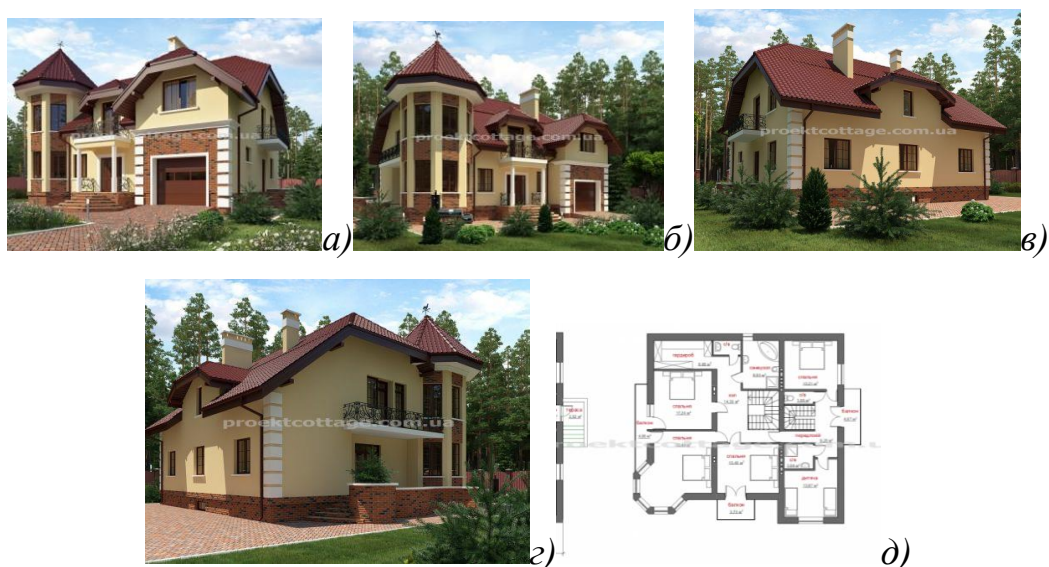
Проєкт великого будинку «Фортуна Дуєт» — 7-кімнатний 1,5-поверховий будинок із гаражем, загальна площа 305,8 м<sup>2</sup>: а) фасад з півдня; б) фасад з південного сходу; в) фасад з півночі; г) фасад зі сходу; д) план мансардного поверху [104].
